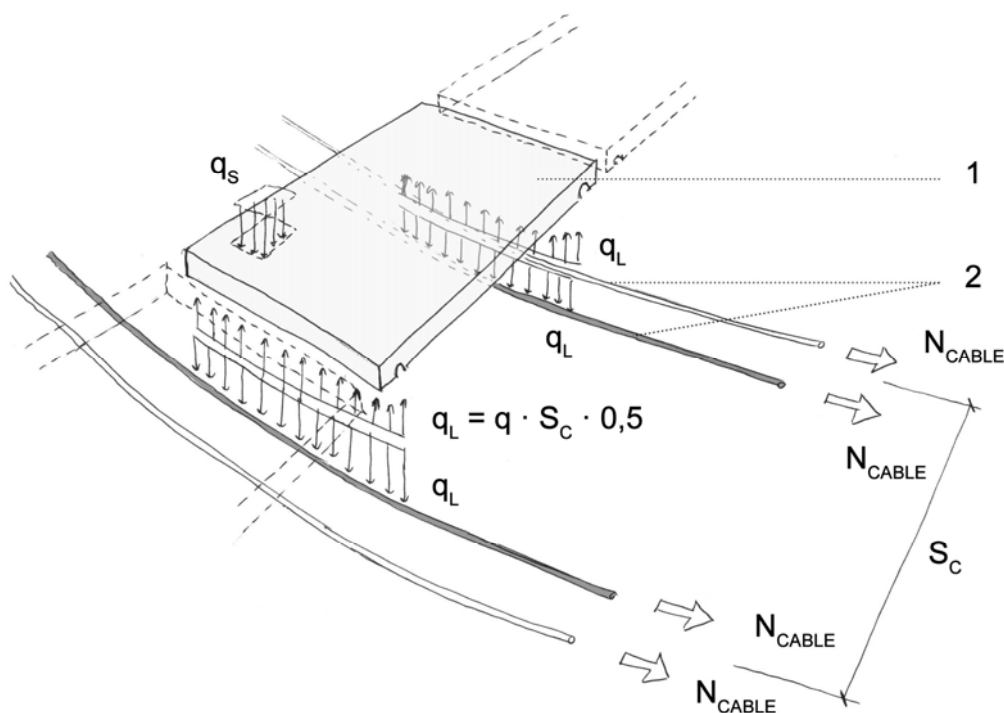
Detalle del apoyo de las placas prefabricadas sobre las barras Gewe. 1 - Placas prefabricadas de hormigón, 2 - Cables de acero, 3 - Viga de borde, 4 - Soporte
